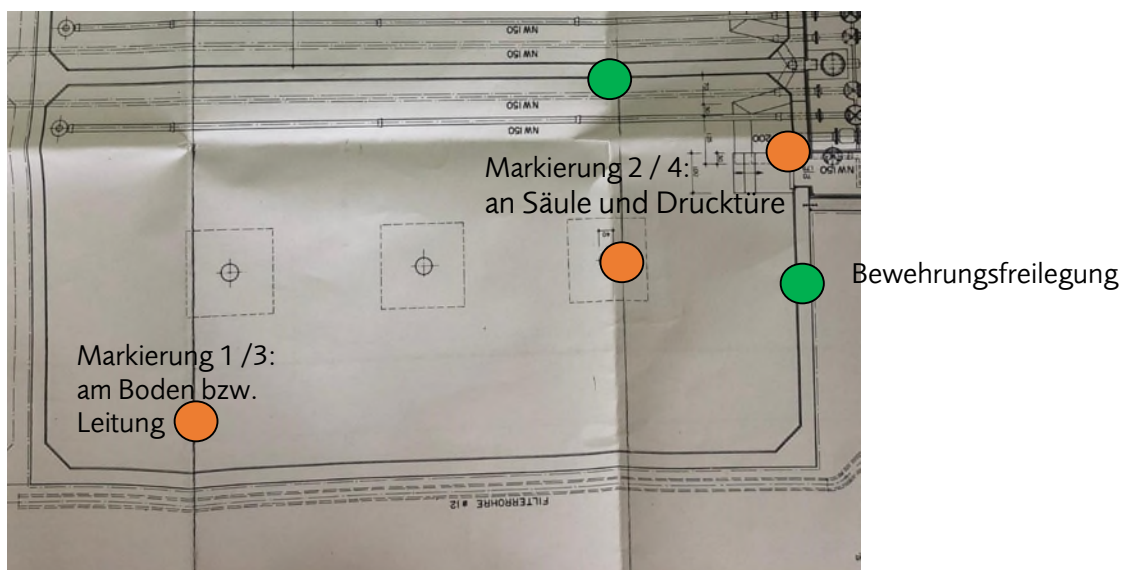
Grundriss der Wasserkammer mit dokumentierten Schäden
